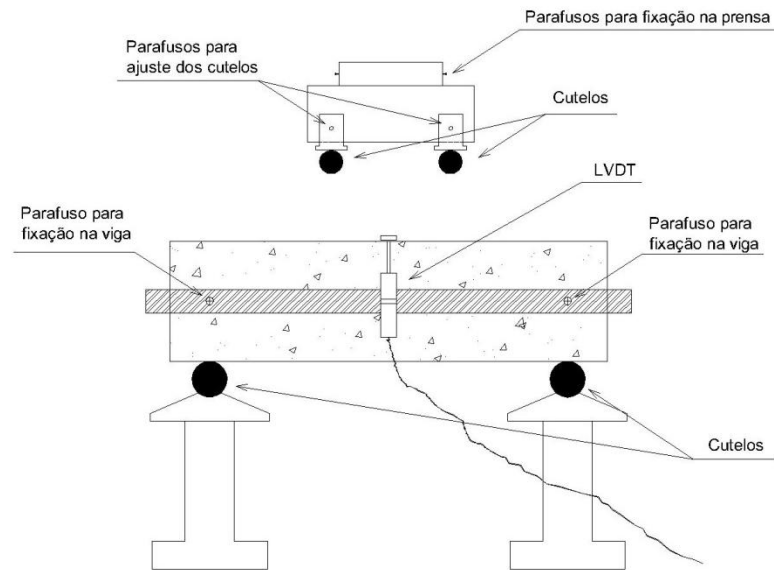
Sistema Yoke para posicionamento dos LVDT na viga – flexão 4 pontos (adaptado de FIGUEIREDO, 2000).
